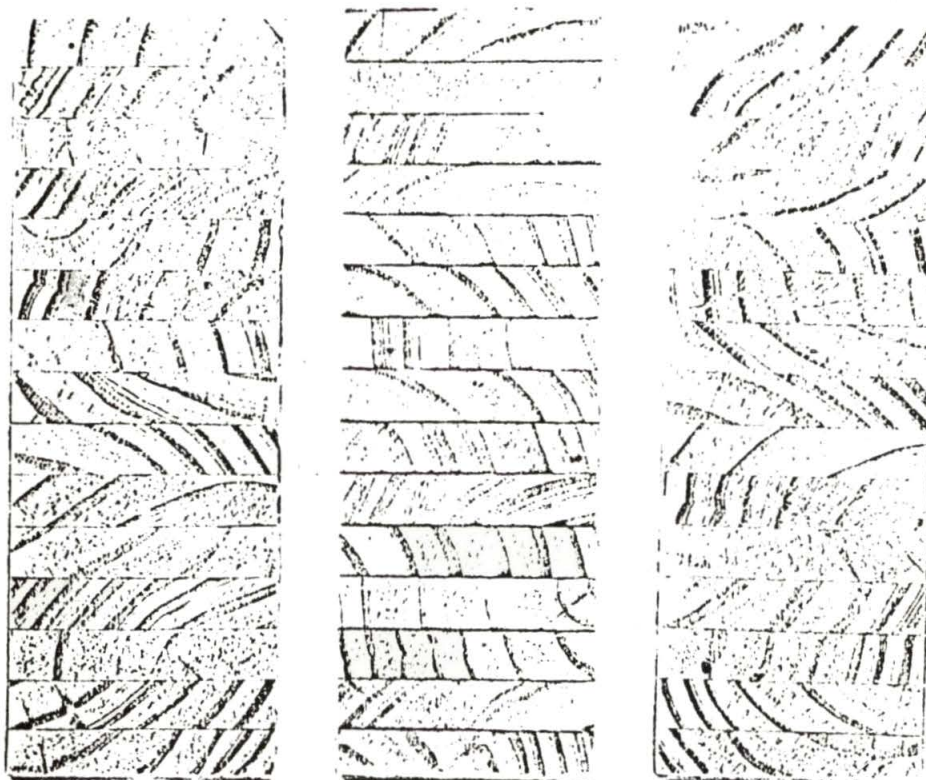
Secção transversal das vigas laminadas VPF (tipo).
